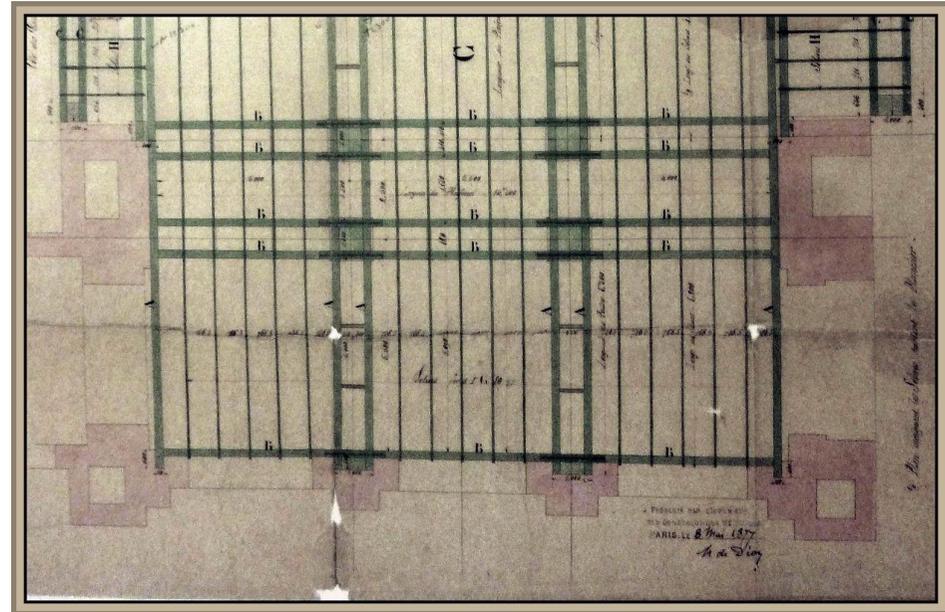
Service de la construction, plan d'étude du plancher, visé par De Dion le 8 mai 1877
